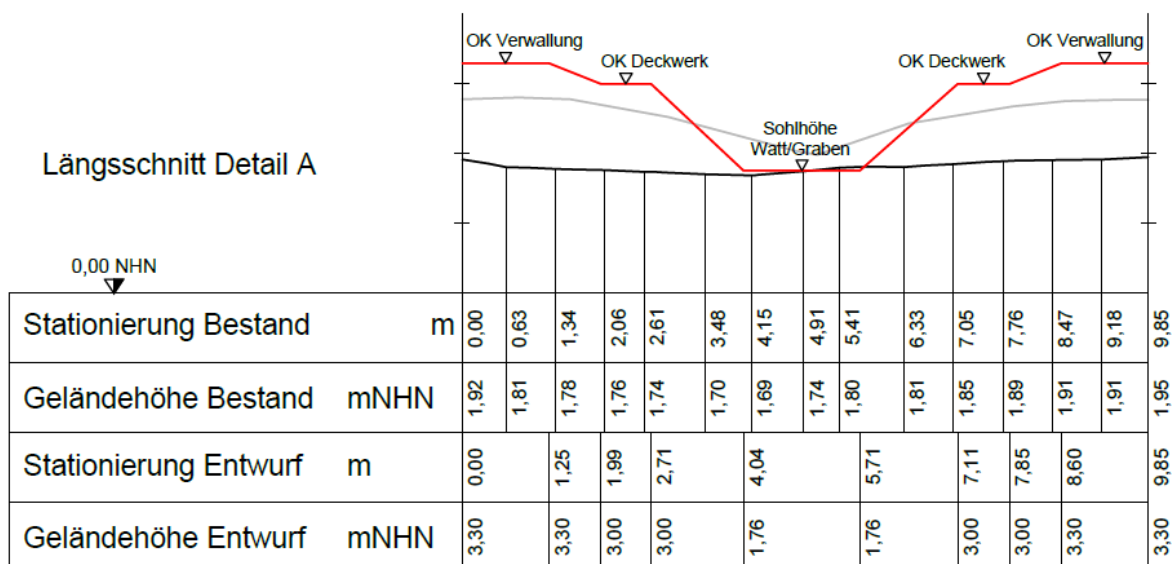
Planausschnitt Detail A (Anlage 2.4.2, Blatt 6), Schwelle im südlichen Abschnitt
